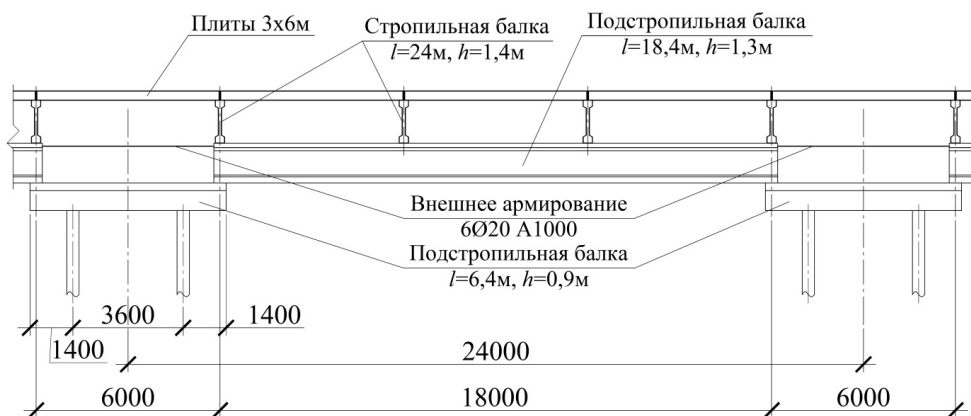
Схема покрытия с внешним армированием подстропильной системы
